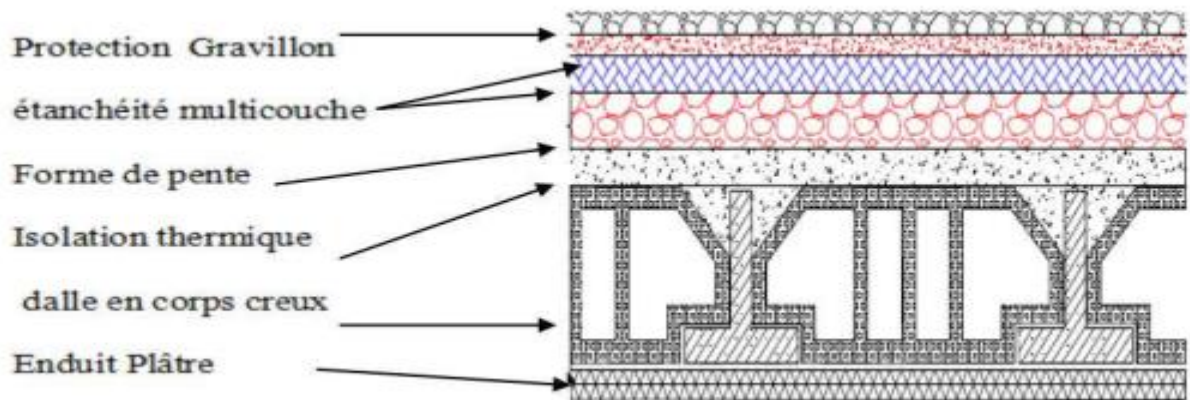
Schéma d'un plancher de terrasse inaccessible
